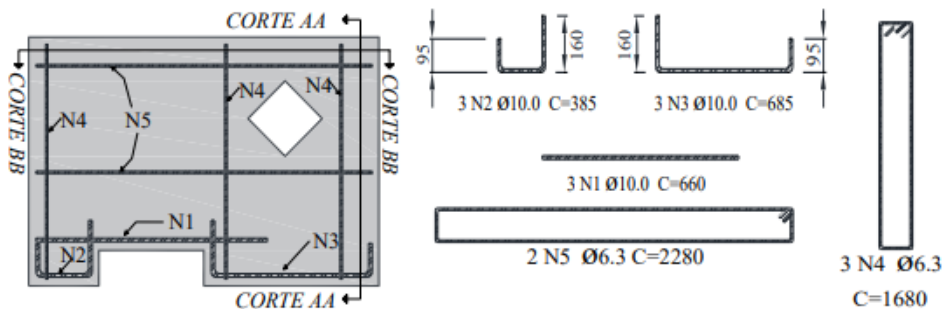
11 – Detalhamento das armaduras DB-WR-H1-NA (dimensões em mm). Neta (2019).
